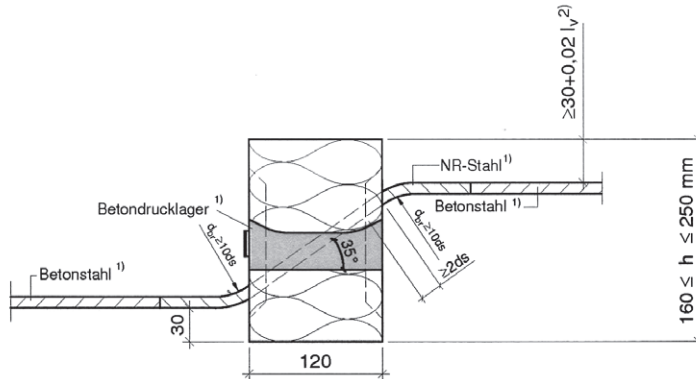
Beispiel Schöck Isokorb Typ RQ-240 mit Betondrucklager
